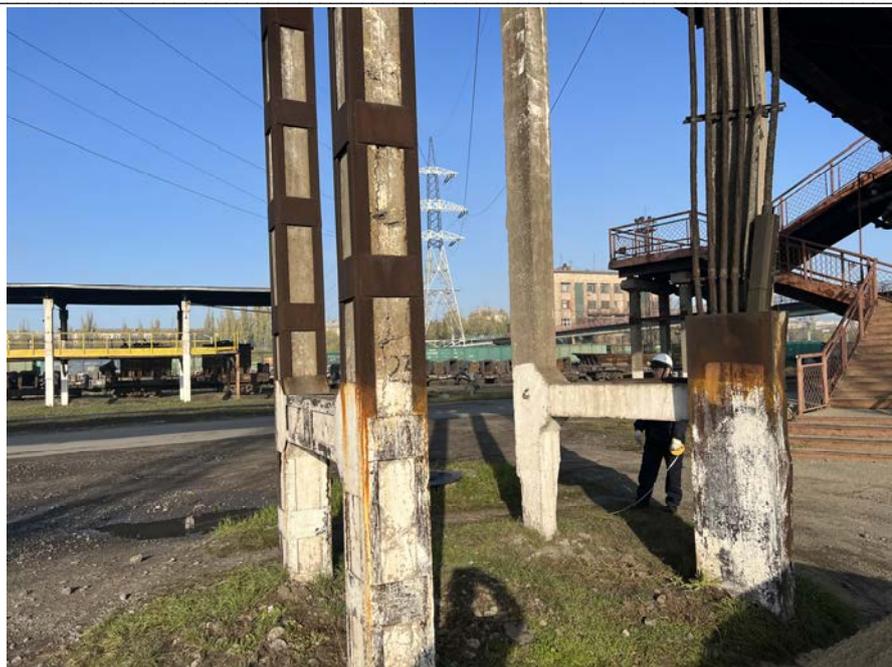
Разрушение усиленных железобетонных опор пешеходной эстакады
